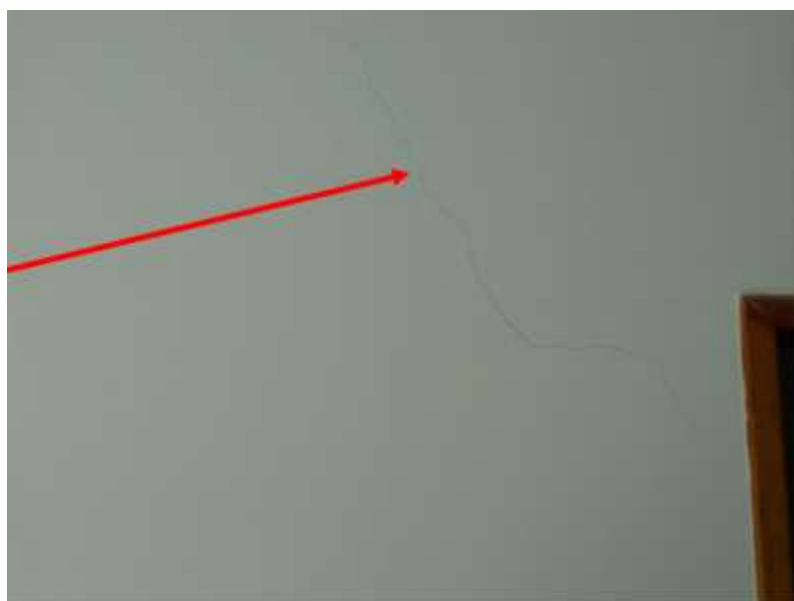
Fissura vertical da vedação (parte interna)
